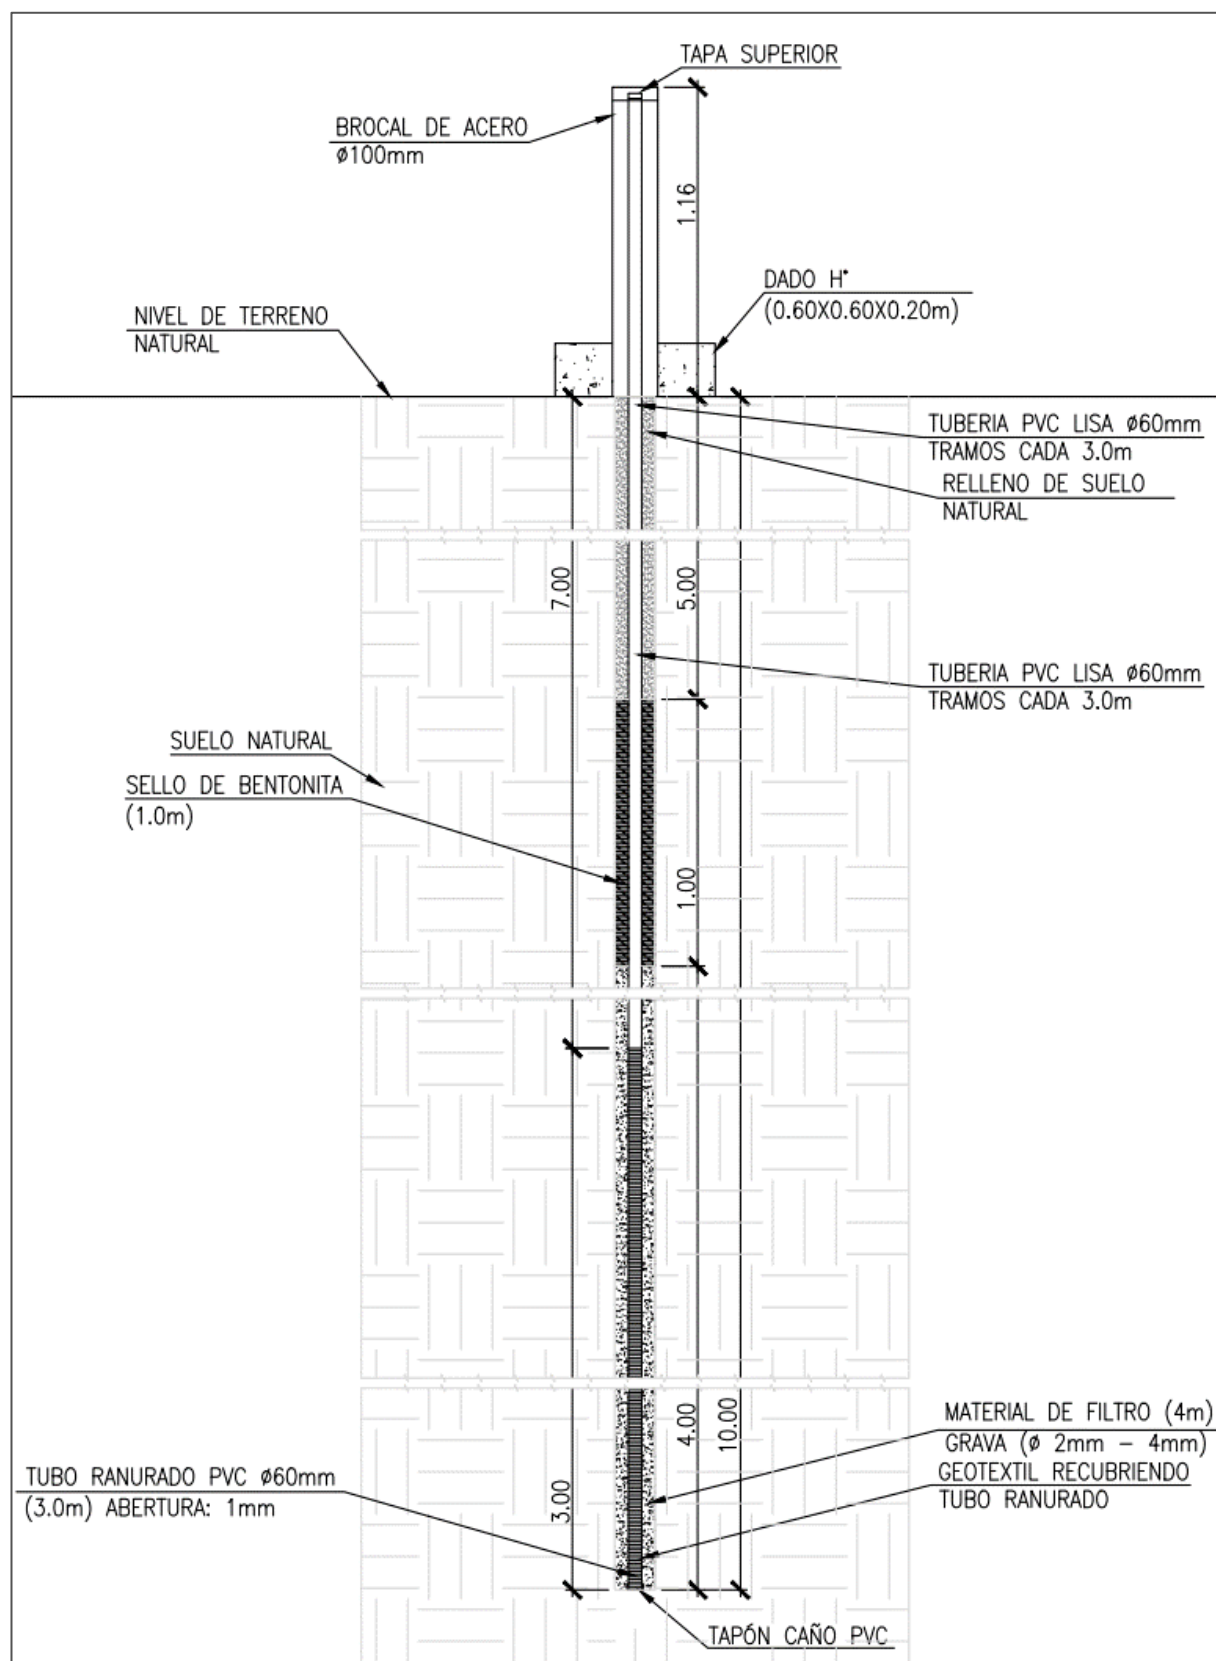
Esquema en detalle del perfil SRK-2023-BH06
